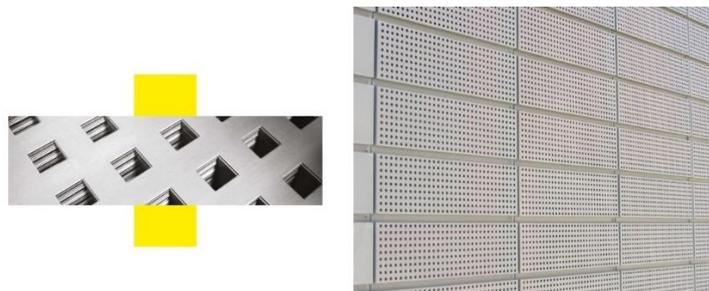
Detalle chapa perforada y aplicación arquitectónica.
